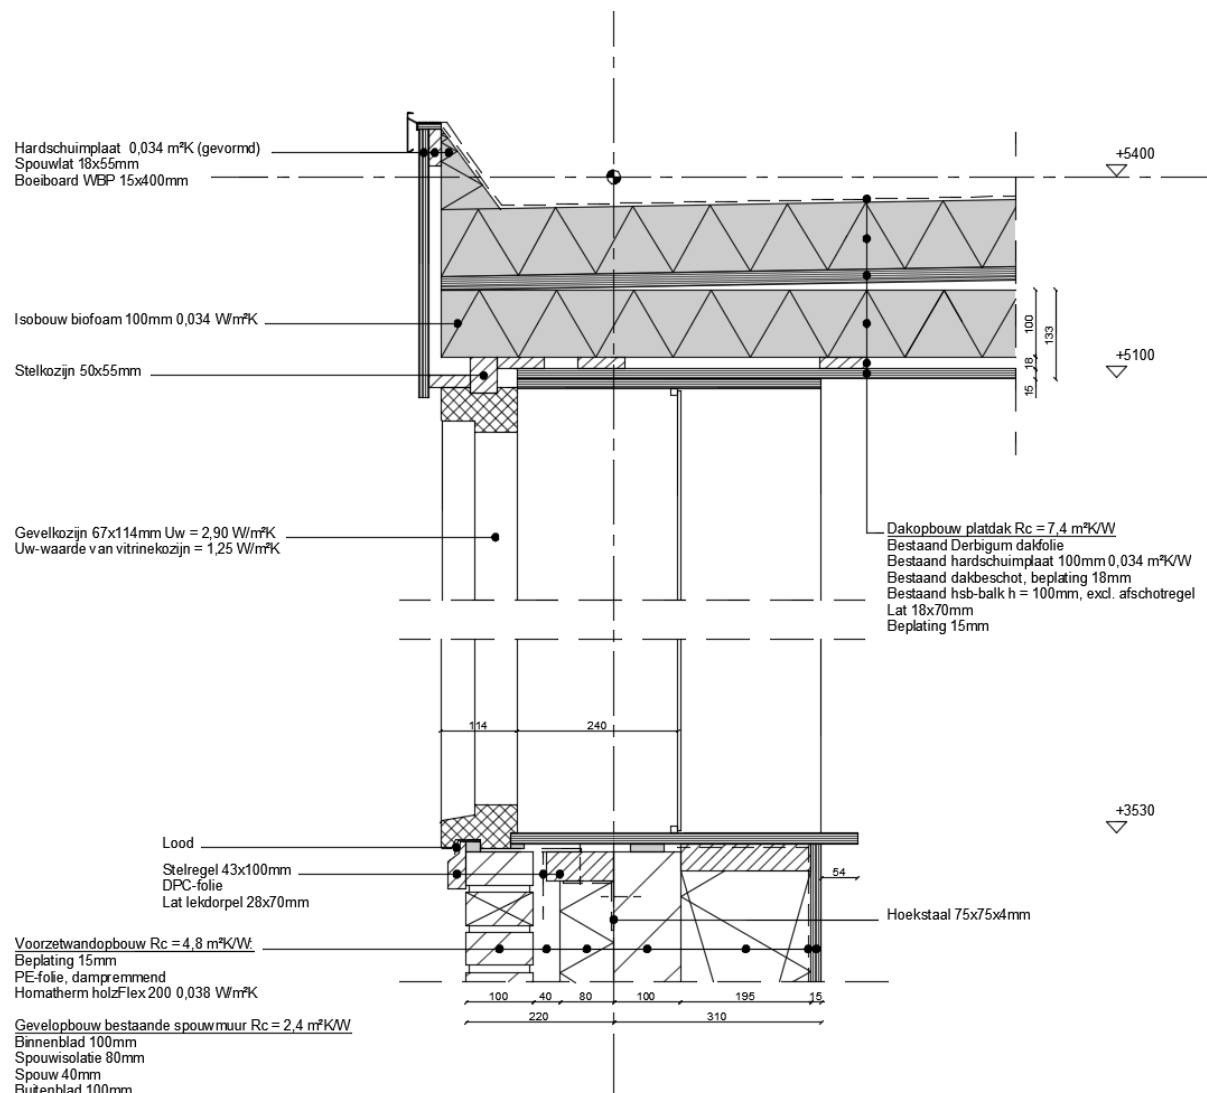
Fragment detailblad 3, binnenbladrenovatie Achterdonk 60, dakconstructie
